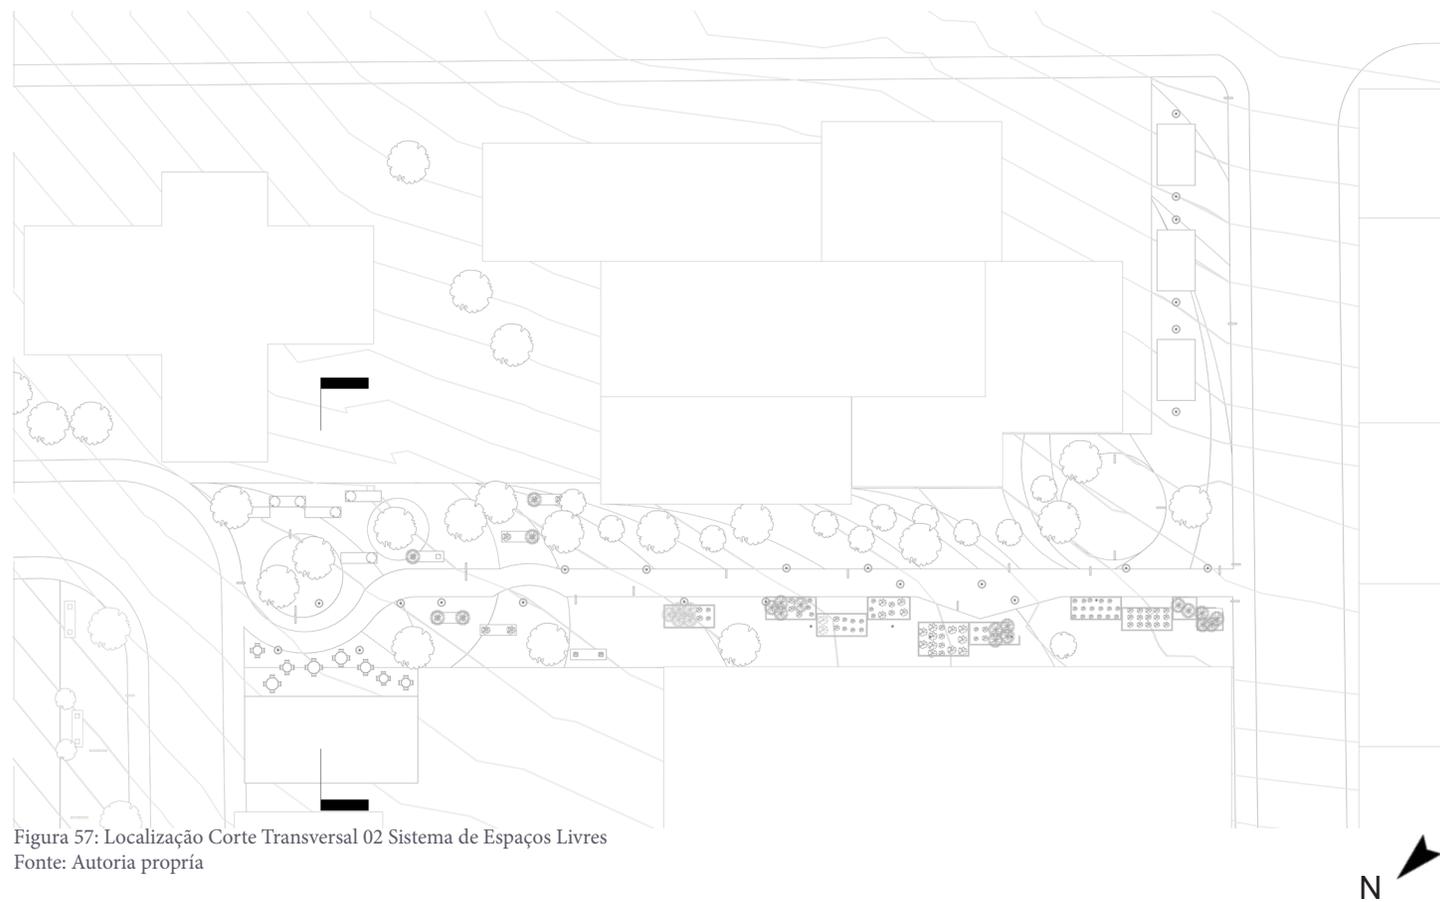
Localização Corte Transversal 02 Sistema de Espaços Livres
